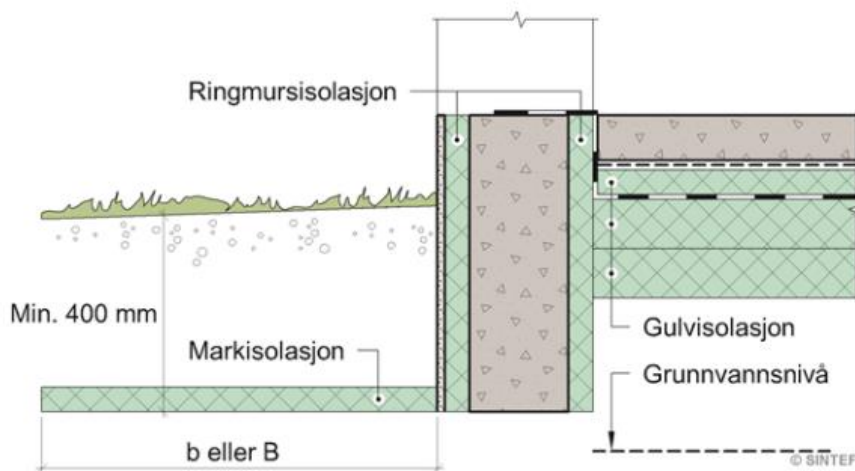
Betonggulv på grunn med underliggende varmeisolering (BKS 522.111).
